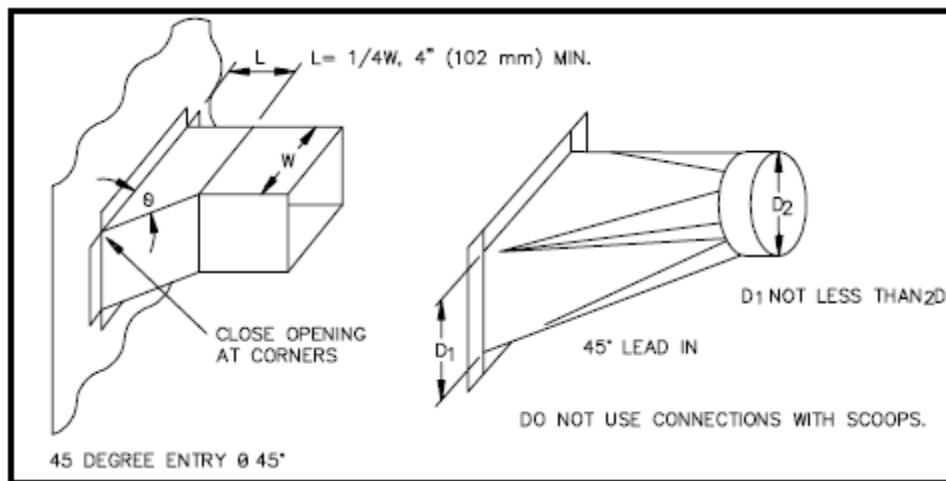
Méthodes de raccordement du conduit central aux branches
